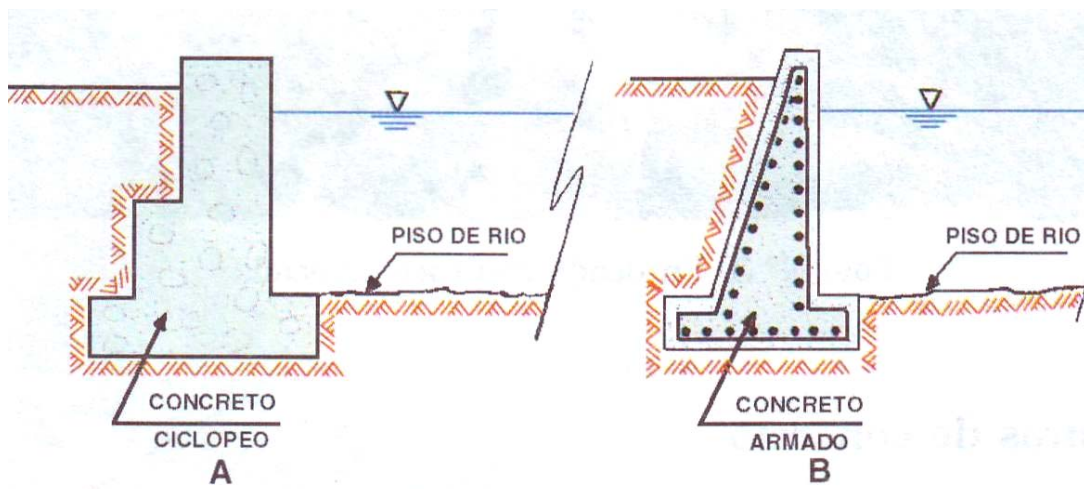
(A y B) Muros de concreto ciclópeo y armado respectivamente
